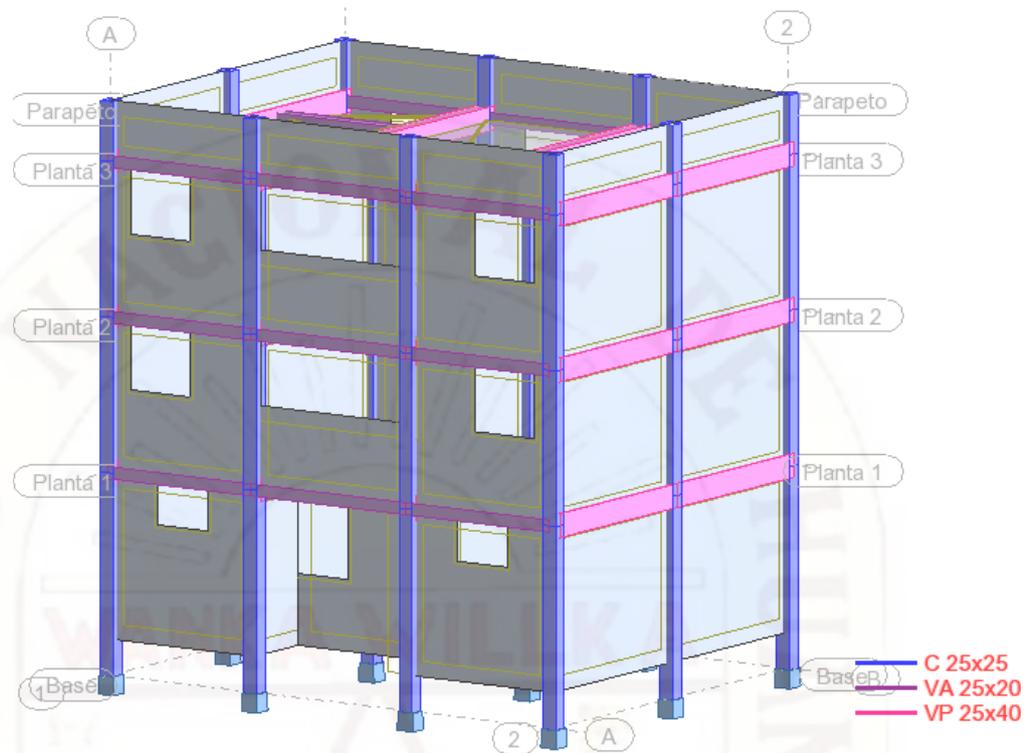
Modelo tridimensional de la edificación mediante el sistema estructural confinado
